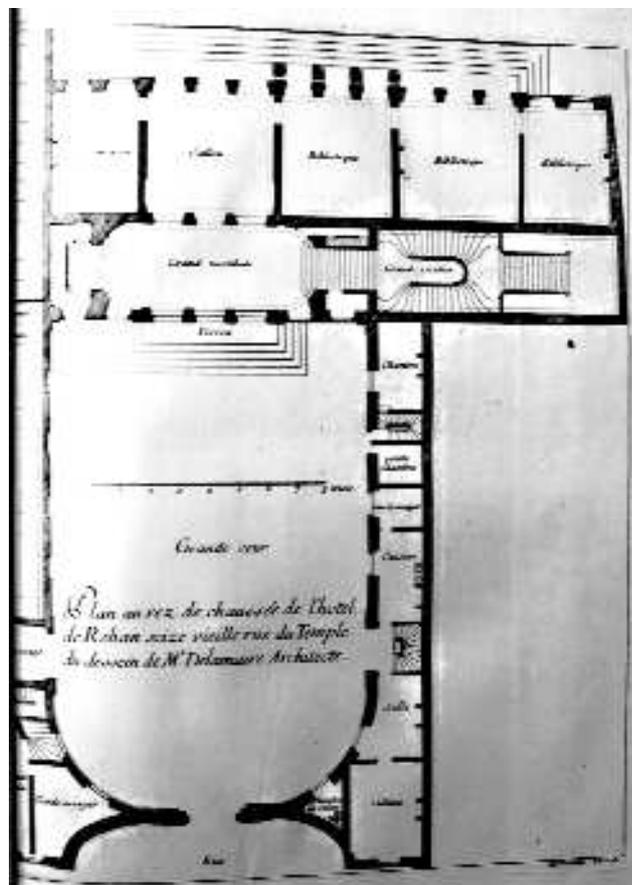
Delamaire, Hôtel de Rohan, Grundriß des Parterre
